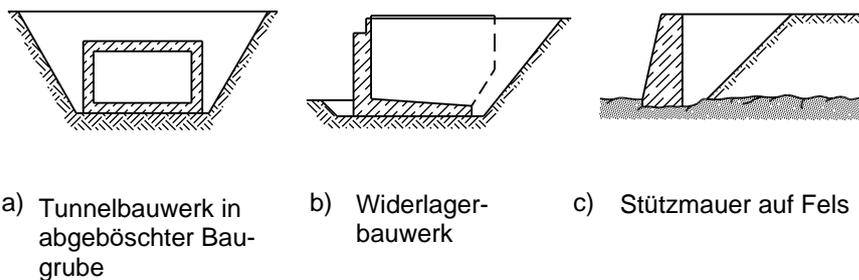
Für den Erdruehdruck zu bemessende Bauwerke
